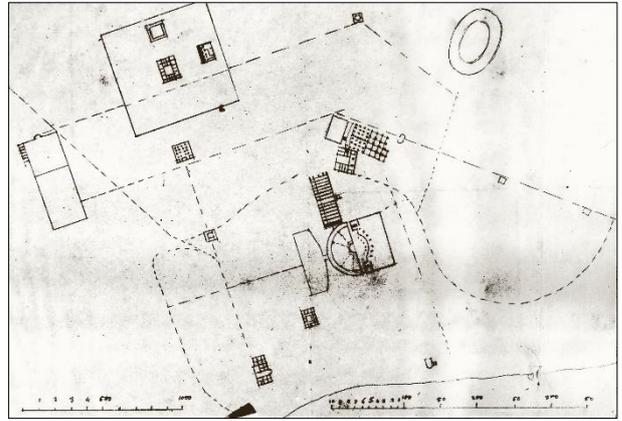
Otricoli. M. GUARDABASSI, planimetria generale, copia della pianta del Pannini.
